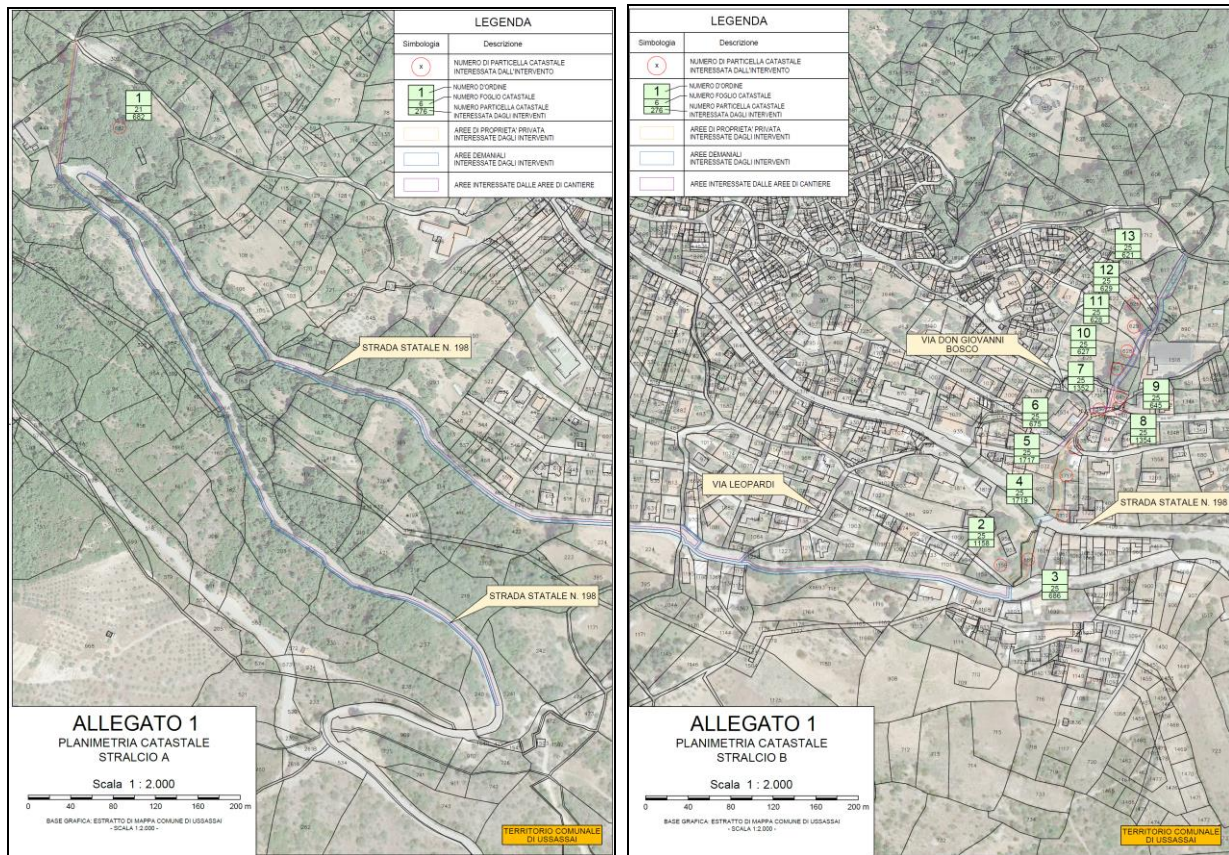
Estratto della planimetria catastale (Stralci A e B)
